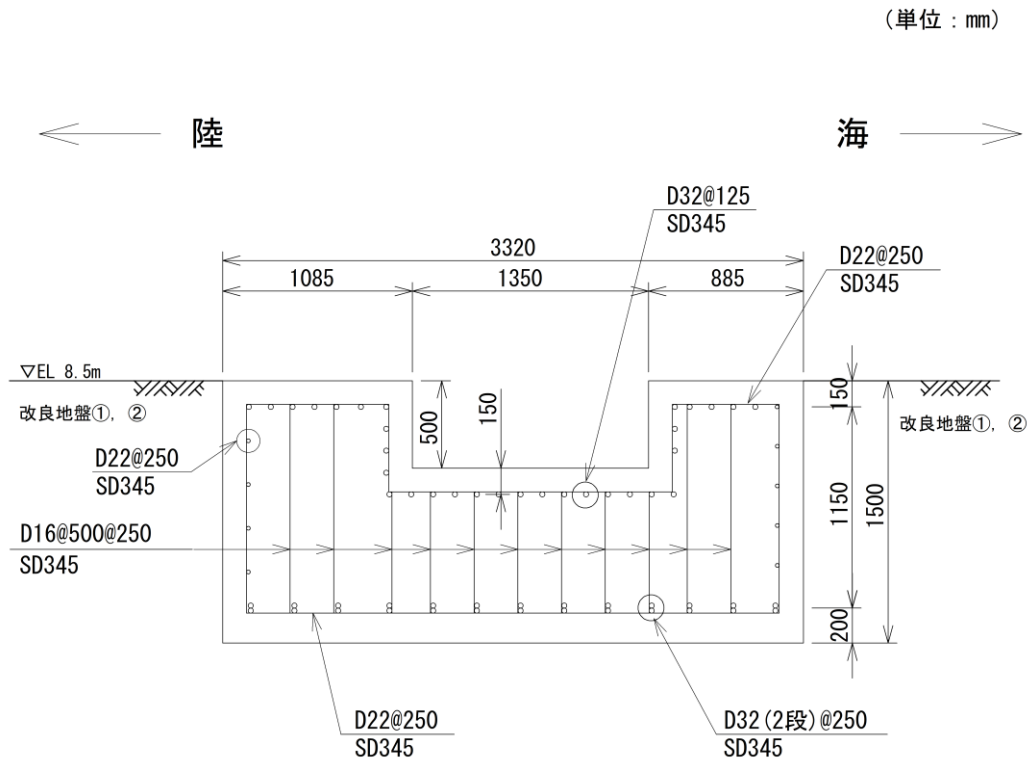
防波扉基礎スラブの概略配筋図 (B-B 断面)
